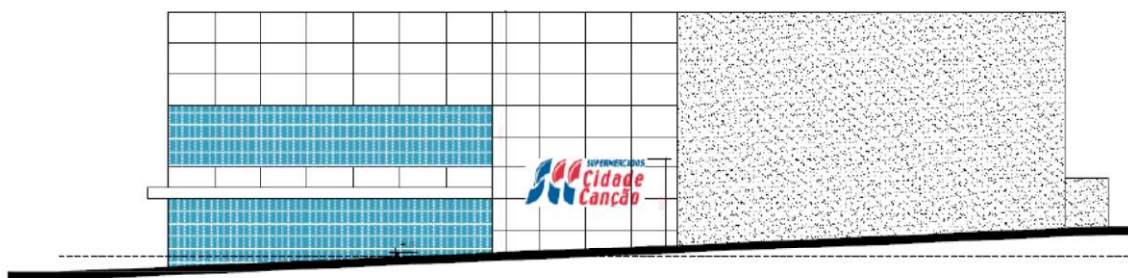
Elevação – Rua Abricó. Fonte: Projeto Arquitetônico.
